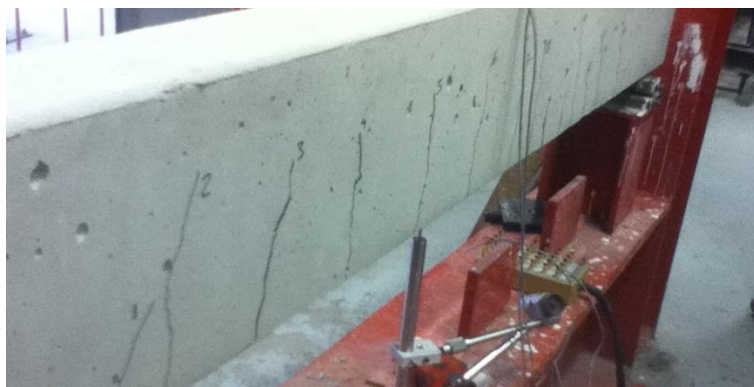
Mode fissuration de la poutre avant renforcement
